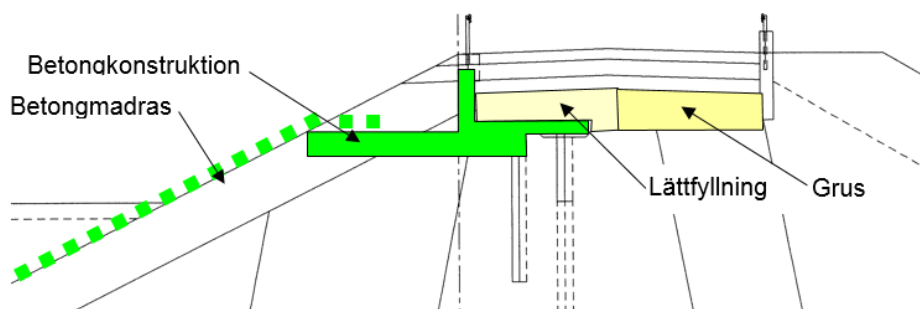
Exempel på stöd mur för höjning av tätning till motsvarande nivå som tätkärnan för övriga dammen vid anslutning till betongkonstruktion.
